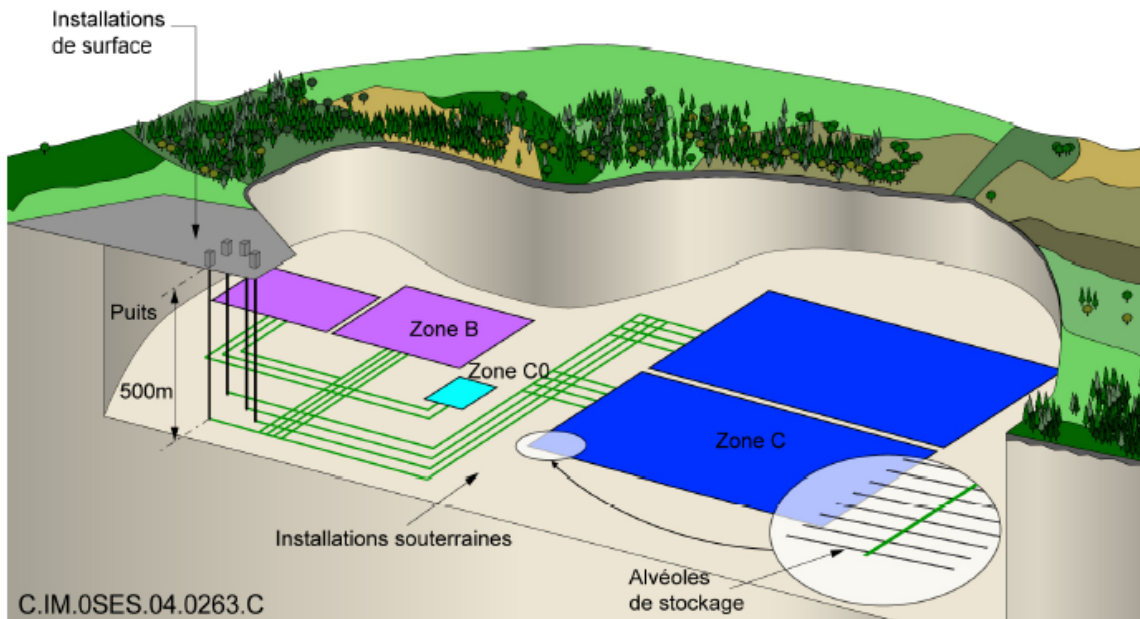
Frankreich – Schematisches Layout des geplanten Endlagers [Haverkate et al. 2006]
